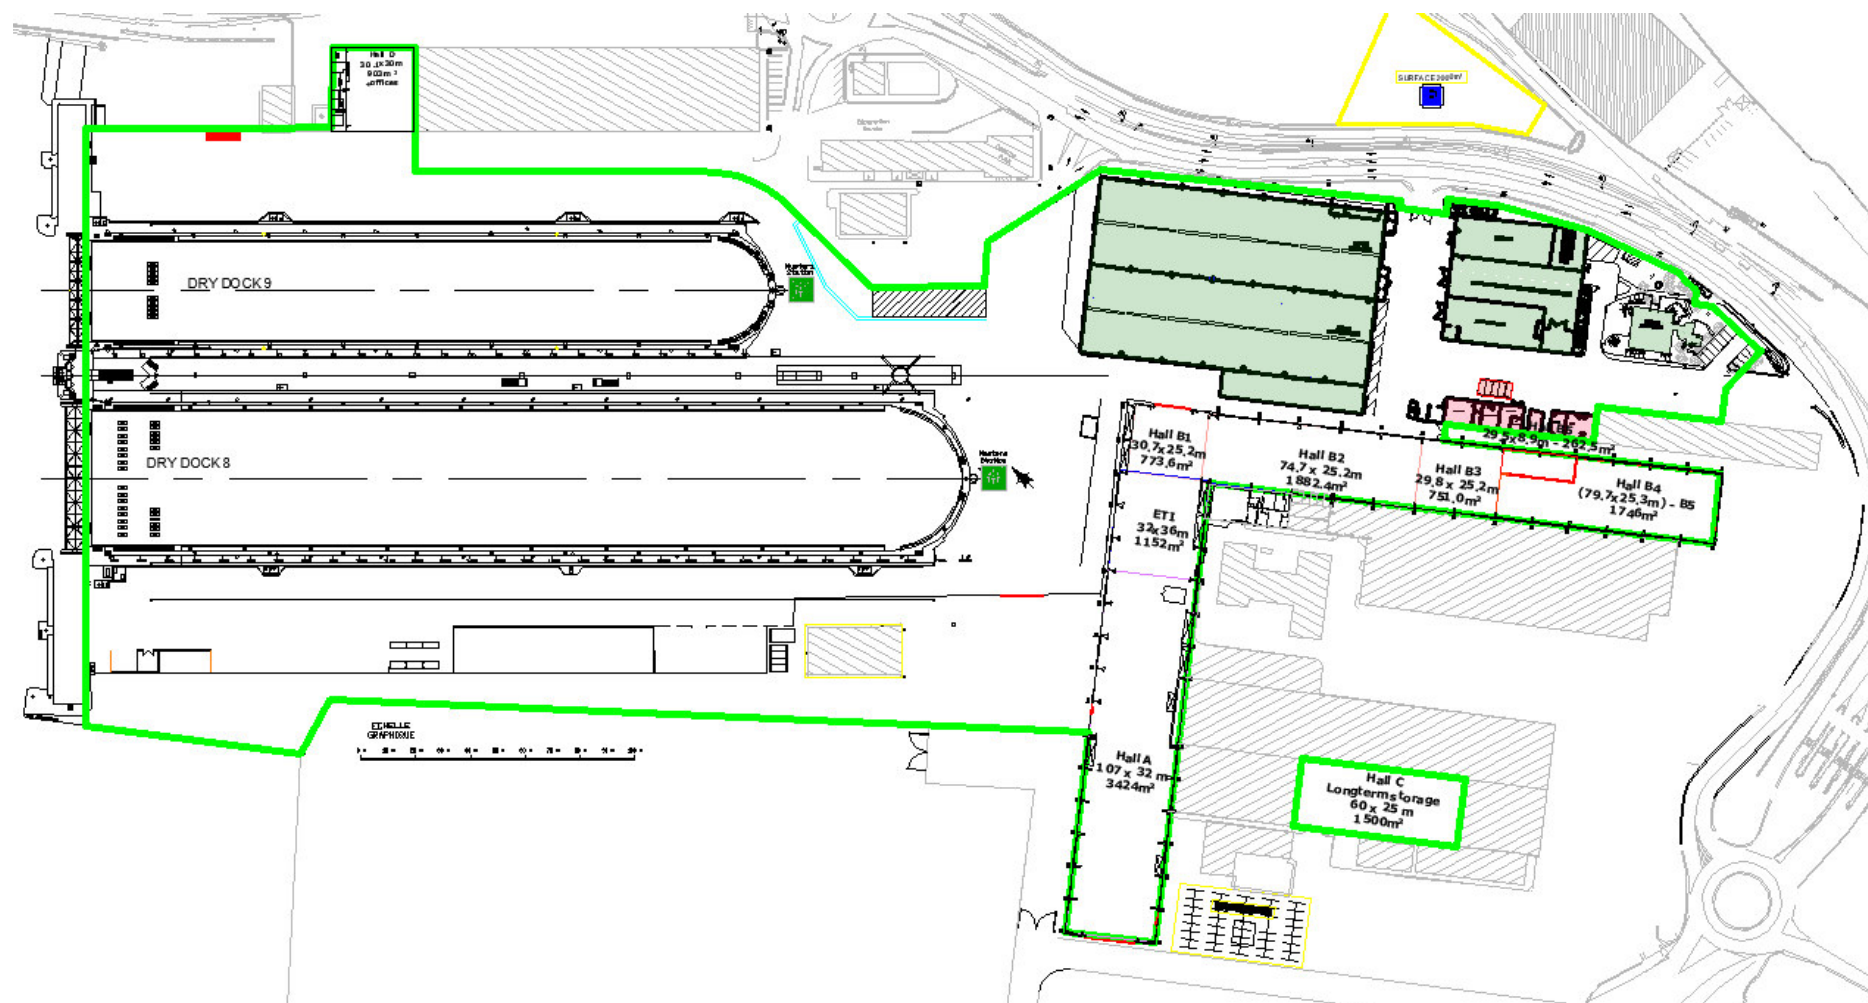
Plan général des installations sur l'enceinte du site CNM Formes 8/9
